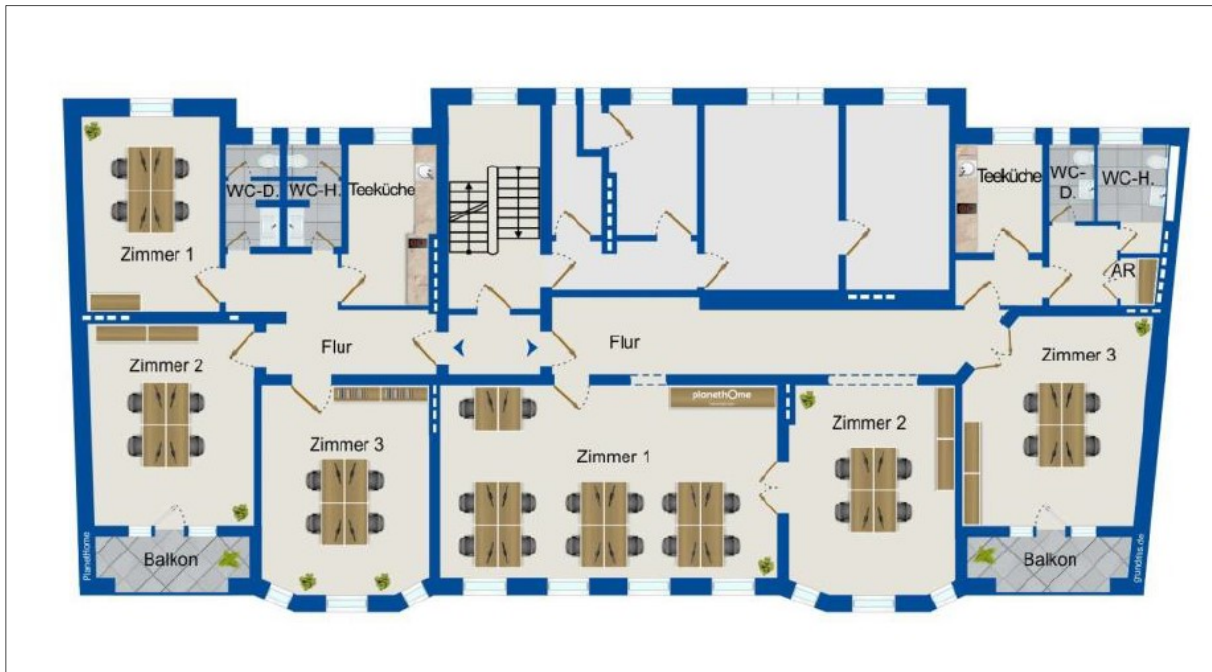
Grundriss Büroetage Wohn- und Geschäftshaus Berlin Zehlendorf
